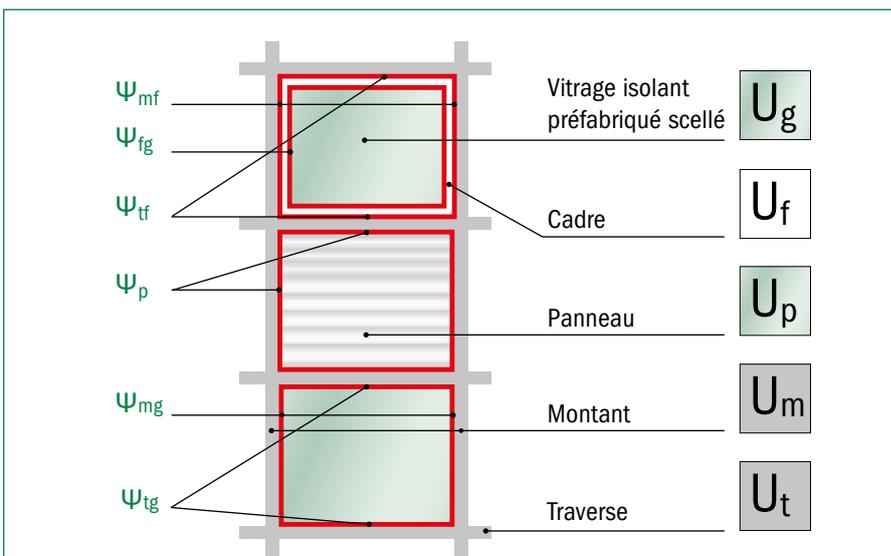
échantillon d'élément de façade selon EN ISO 12631 [3]
